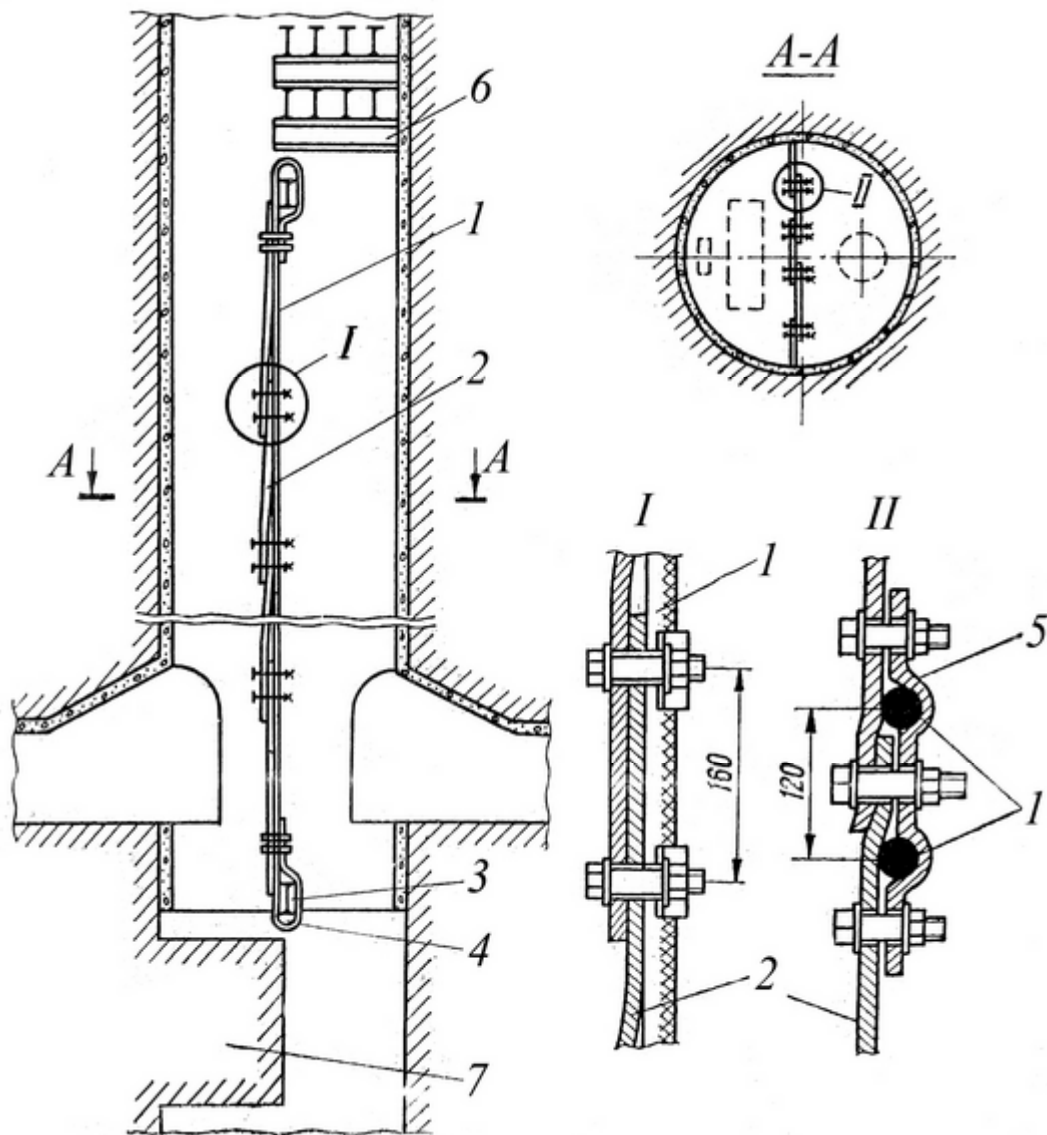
Конструкция разделительной стенки с несущими элементами из вертикально натянутых стальных канатов:
